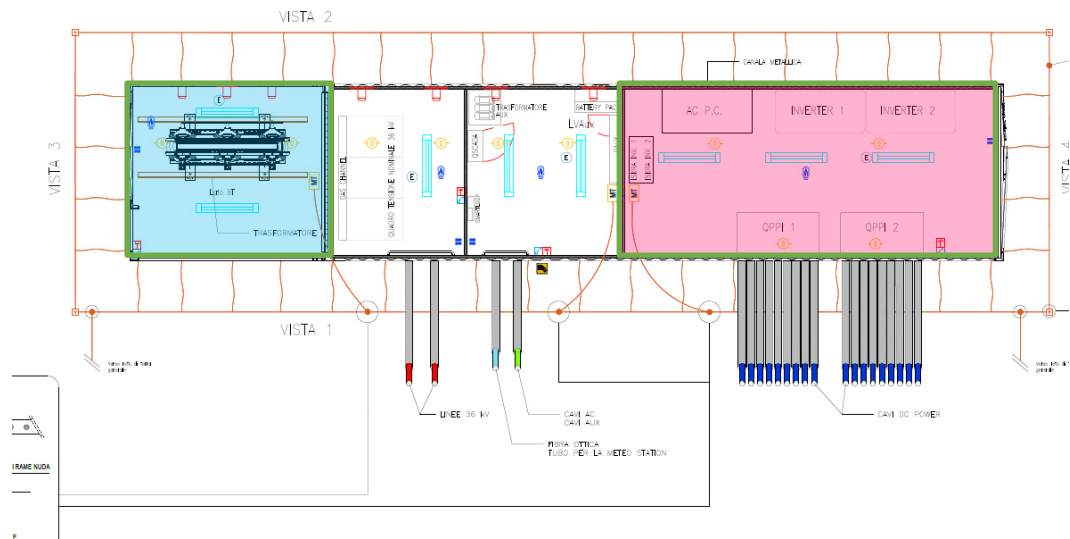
Layout cabina elettrica – Pianta - (Power Station)
